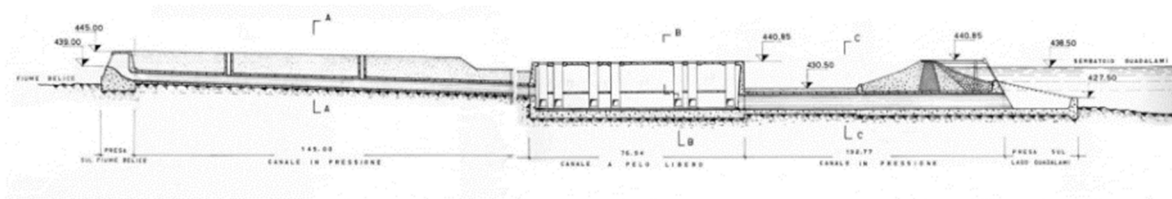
Profilo longitudinale canale di presa e restituzione (ENEL, 2013)
